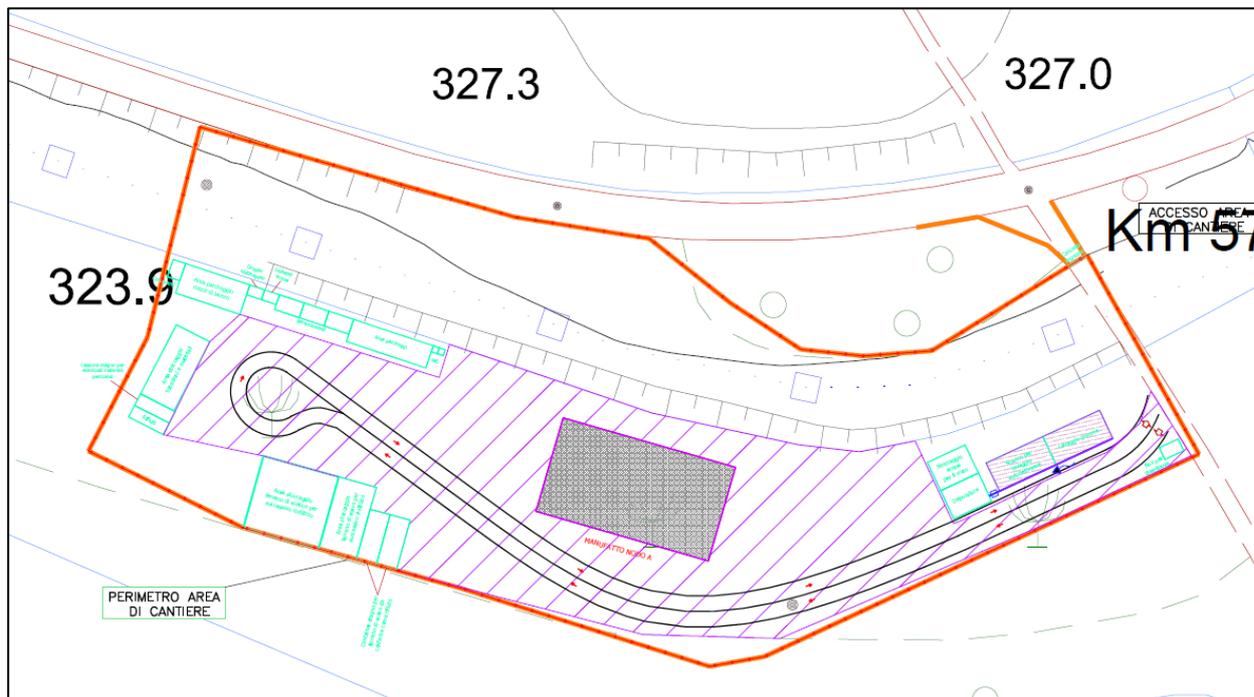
Stralcio planimetrico area di cantiere Manufatto Nodo A
